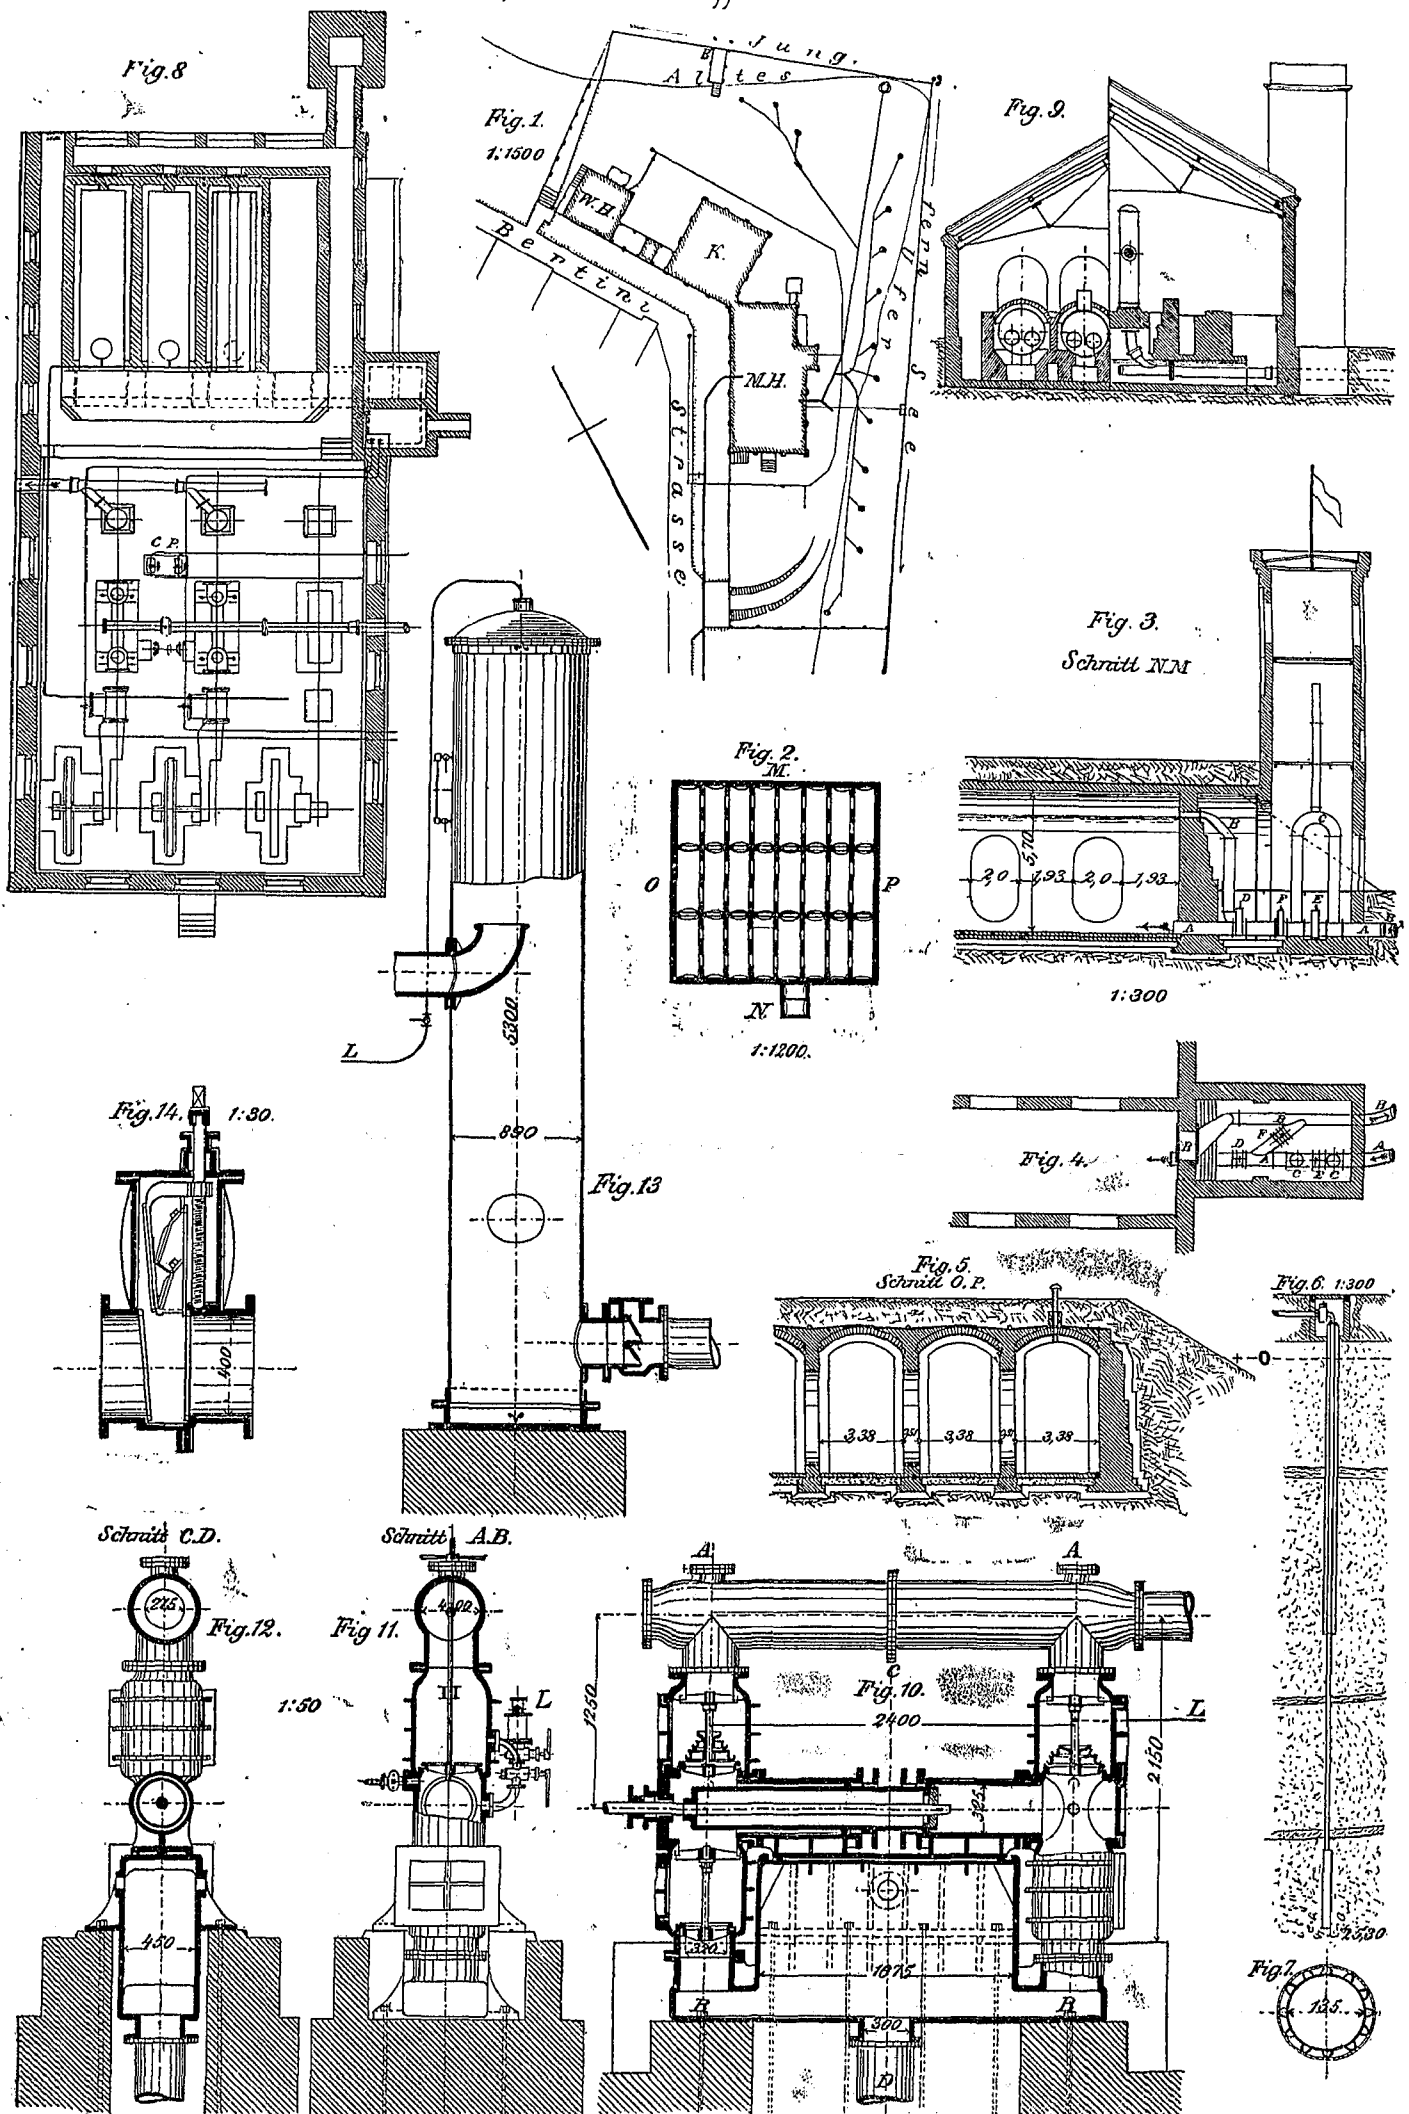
Situat.-Pl. d. Pump-Station. Fig. 2. Reservoir. (Grundriss.) Fig. 3. Reservoir-Thurm. (Längenschnitt.) Fig. 4. Ventilkammer. (Grundriss.) Fig. 5. Reservoir. (Querschnitt.) Fig. 6. Rohrbrunnen. Fig. 7. Brunnen-Sieb. Fig. 8. Masch.-u. Kesselhaus. (Grundriss.) Fig. 9. Masch.-u. Kesselhaus. (Querschnitt.) Fig. 10. Pumpen. (Längenschnitt.) Fig. 11. do. (Querschnitt.) Fig. 12. Rückschluss-Ventil zum Reservoir. Fig. 13. Windkessel. Fig. 14. Rückschluss-Ventil zum Reservoir.
